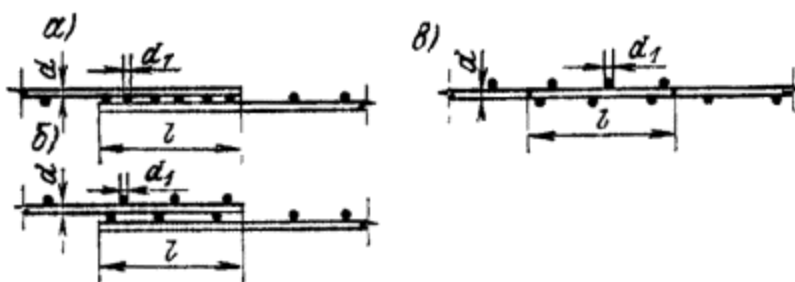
Стыки сварных сеток внахлестку (без сварки) в направлении рабочей арматуры, выполненной из гладких стержней
